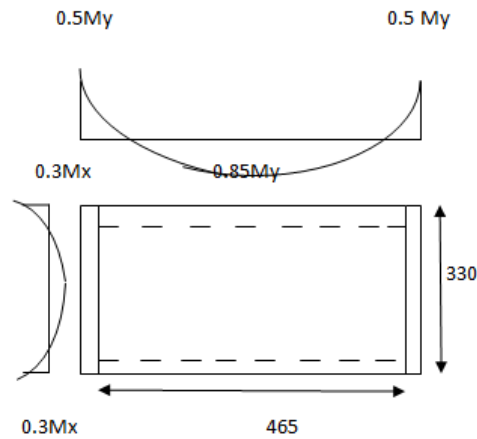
panneau de dalle appuie sur 4 coté
